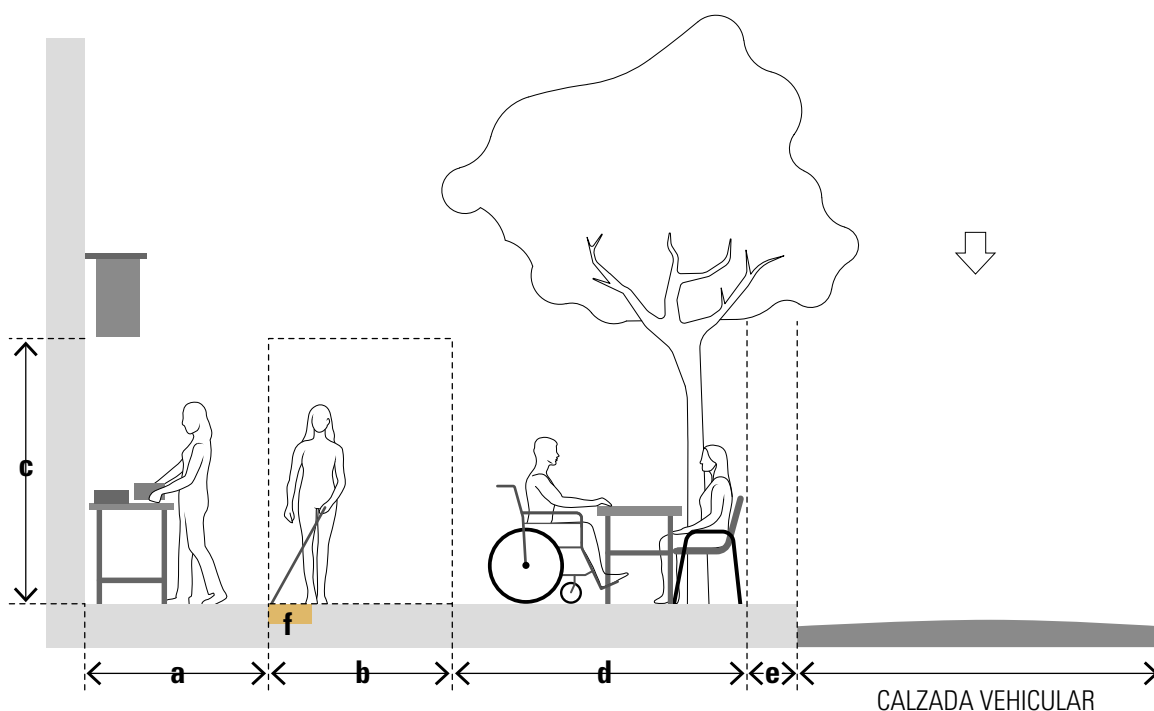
Sección de calle con banqueta ancha e IPA ubicado junto a la línea edificada
